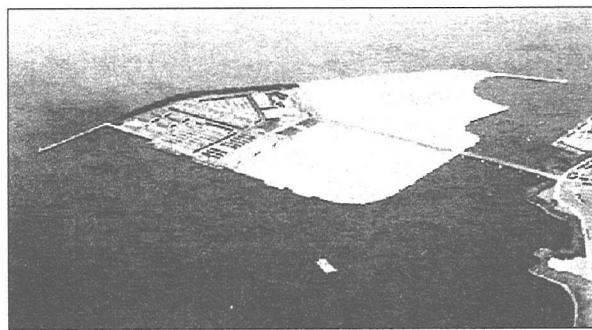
下関沖合人工島(ひびくらんど)計画平面図
